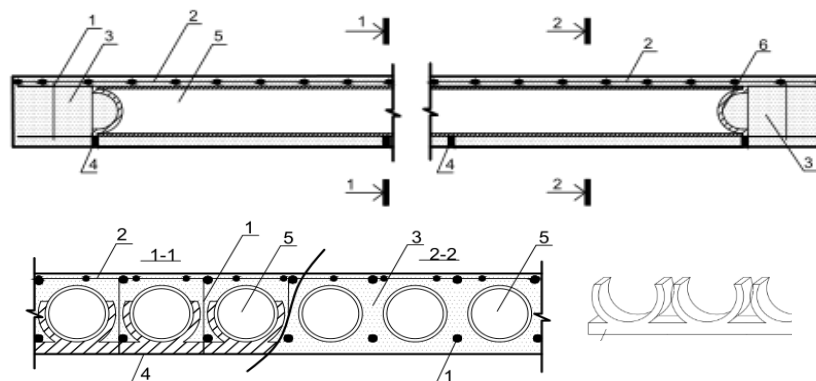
Продольный и поперечные разрезы плиты перекрытия: 1 – вертикальная арматура; 2 – горизонтальная сетка арматуры; 3 – монолитный бетон; 4 – подкладка; 5 – труба-вкладыш; 6 – заглушки по торцам будущей плиты
